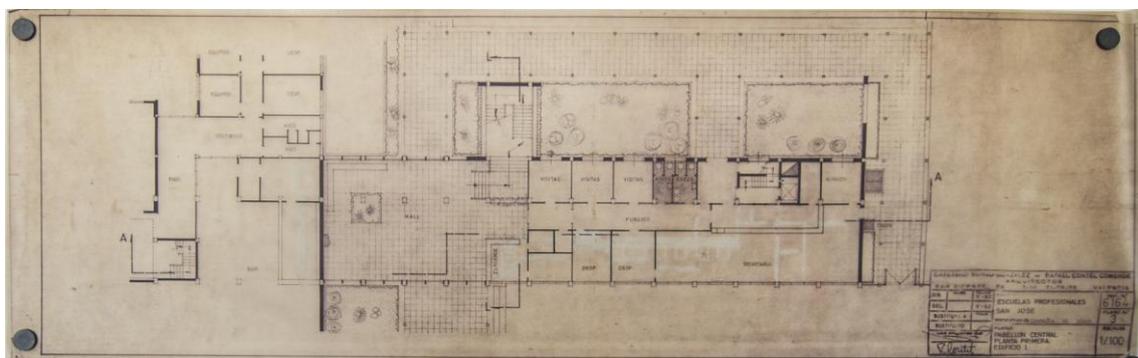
Planta baja. *Archivo Escuelas San José.
